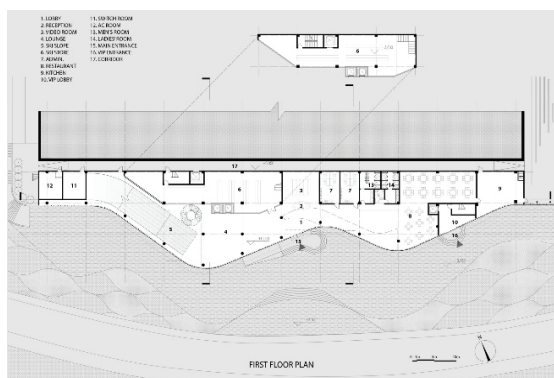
План 1-го этажа БГК «Yunmen Mountain».
